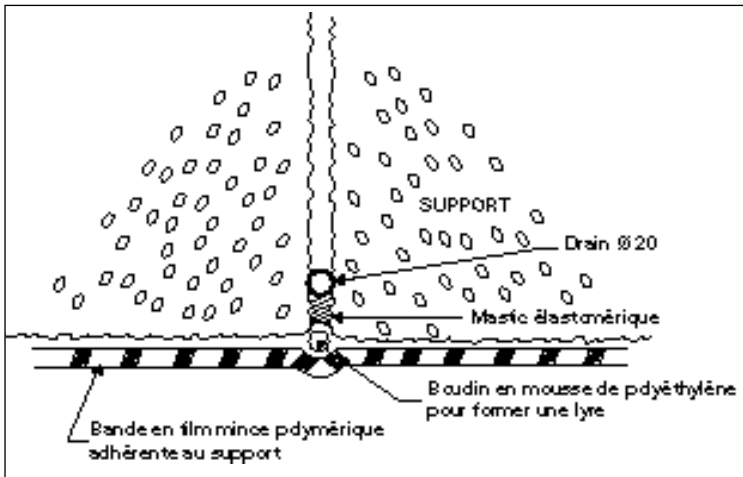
Drainage avec drain interne et bande de pontage par film mince adhérente au support ▲
